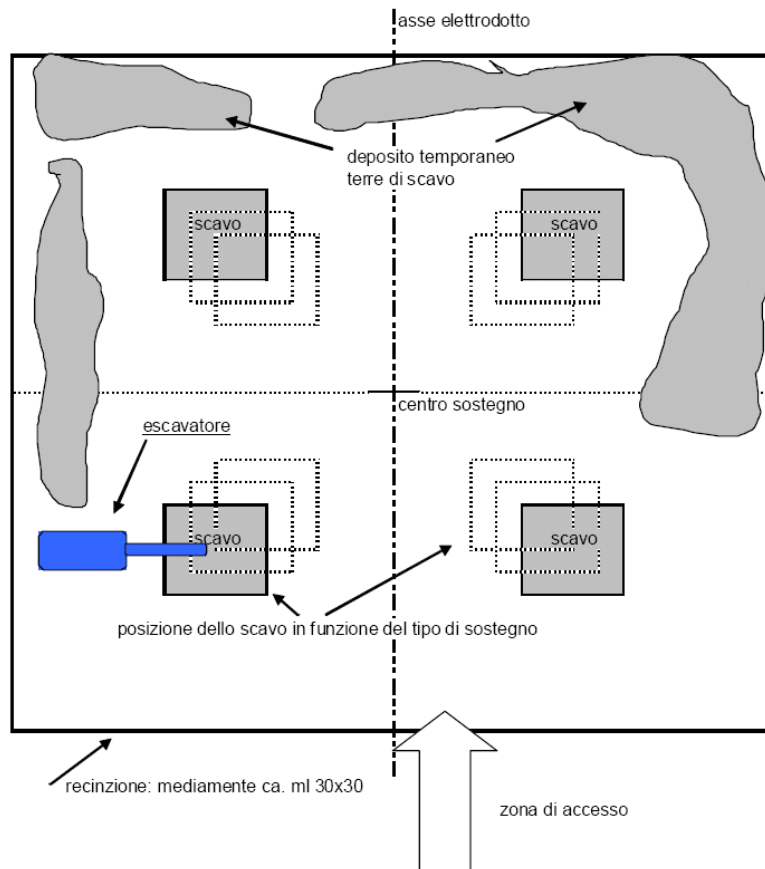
Planimetria dell'area di sostegno (scavo di fondazione)
